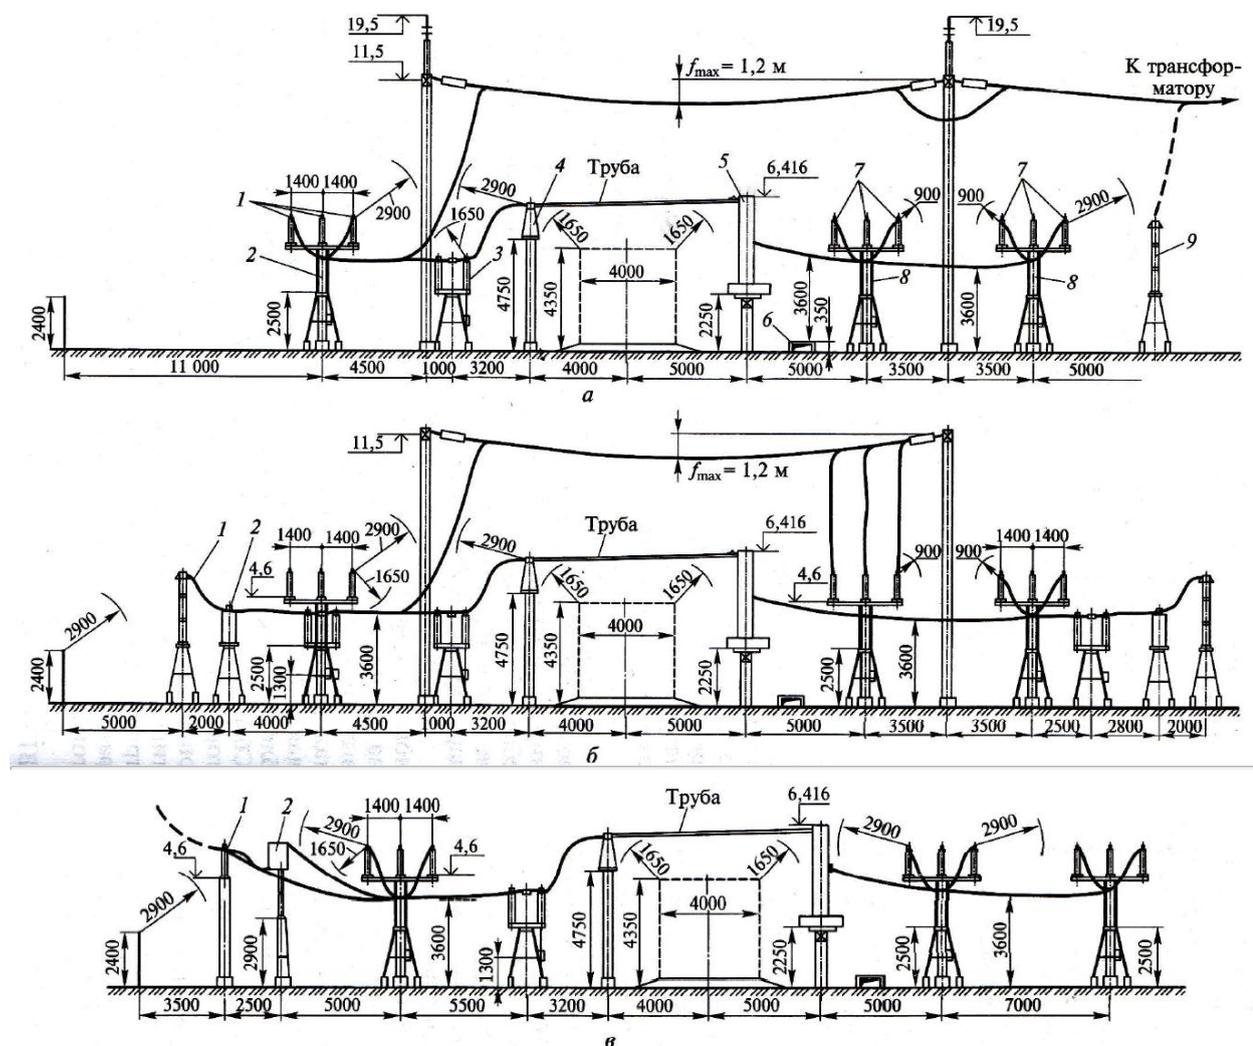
ОРУ 110 кВ из крупных блоков заводского изготовления с маломасляными выключателями по схеме с двумя рабочими и обходной системами шин:
